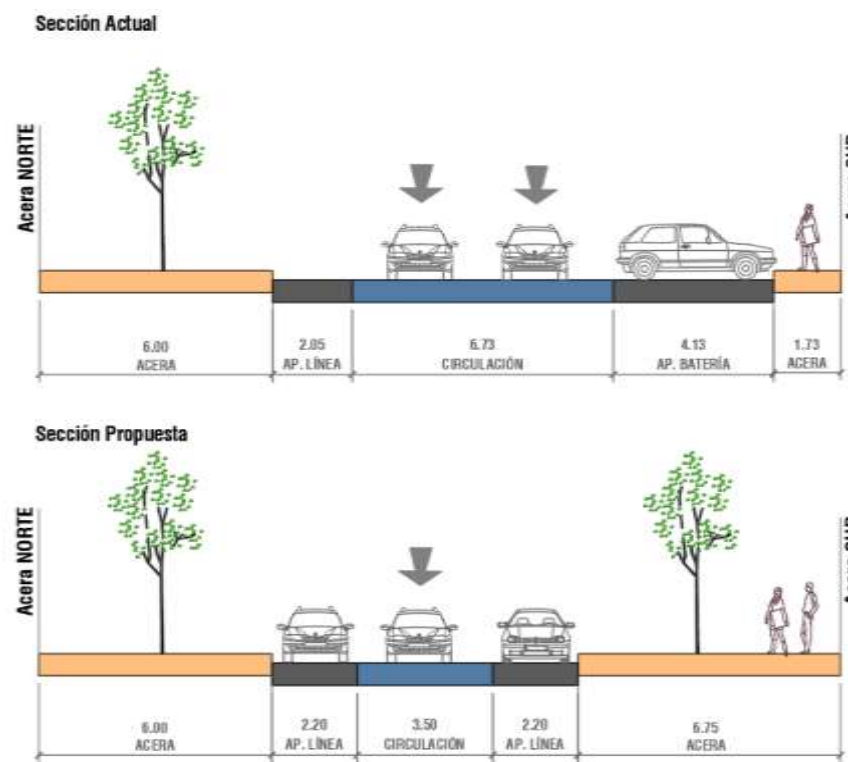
Sección tipo F propuesta en calle Real. Fuente: DOYMO.
